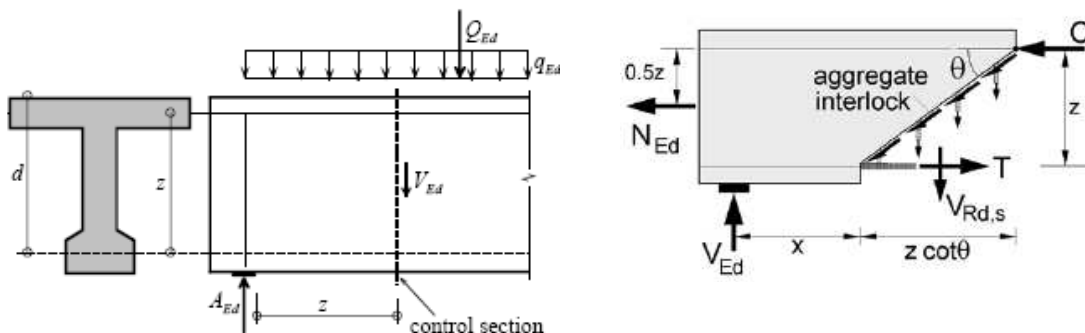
Sección de control y fuerzas en el alma de una viga
